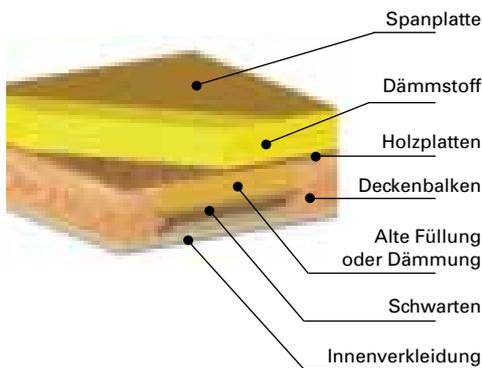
Prinzipieller Aufbau einer Dämmung der obersten Geschossdecke.
